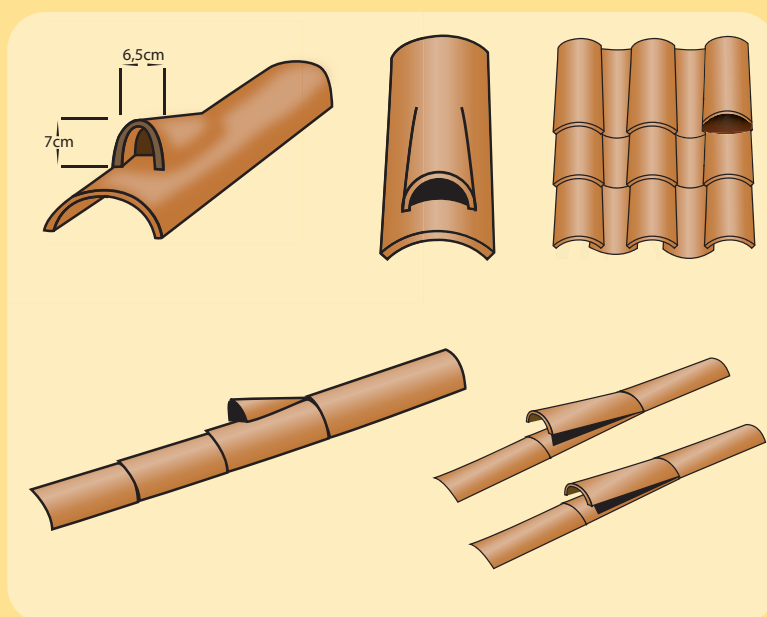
Schema di tegola di ventilazione che consente il restauro completo del tetto e permette l'utilizzo dello stesso per la nidificazione del Grillaio.
